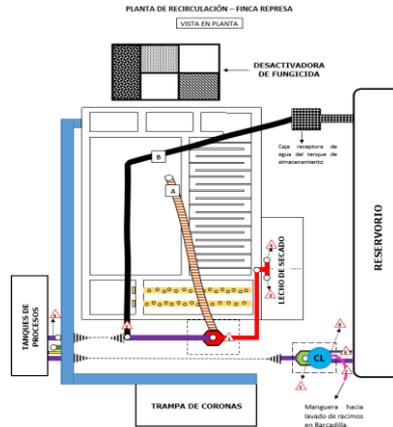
Vista en planta de la planta de recirculación de agua de la finca Represa.
